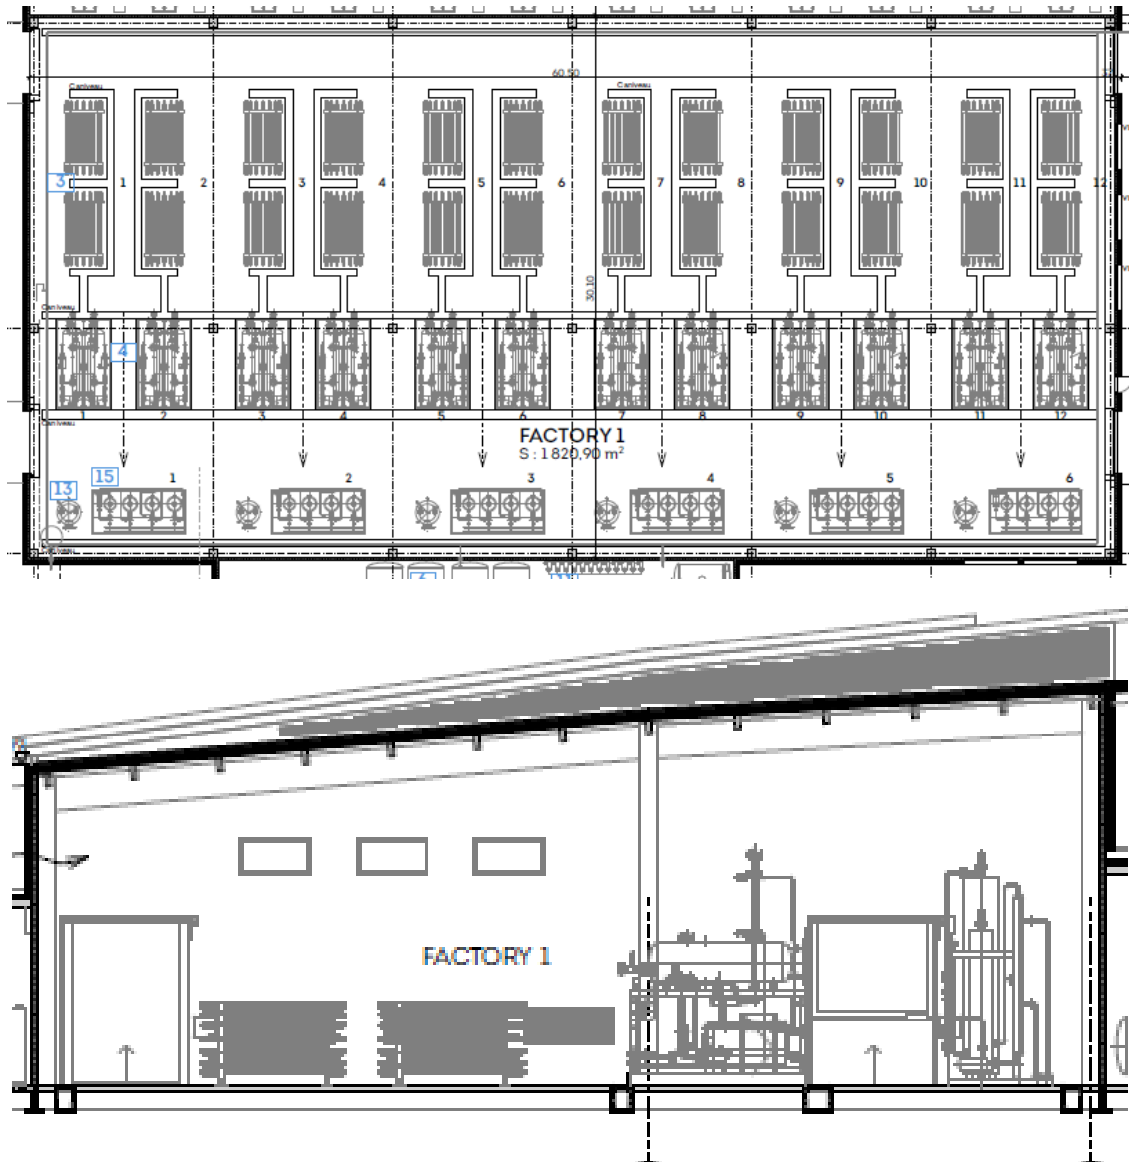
Plan du bâtiment électrolyseur : vue en plan (en haut) et en coupe (en bas)
